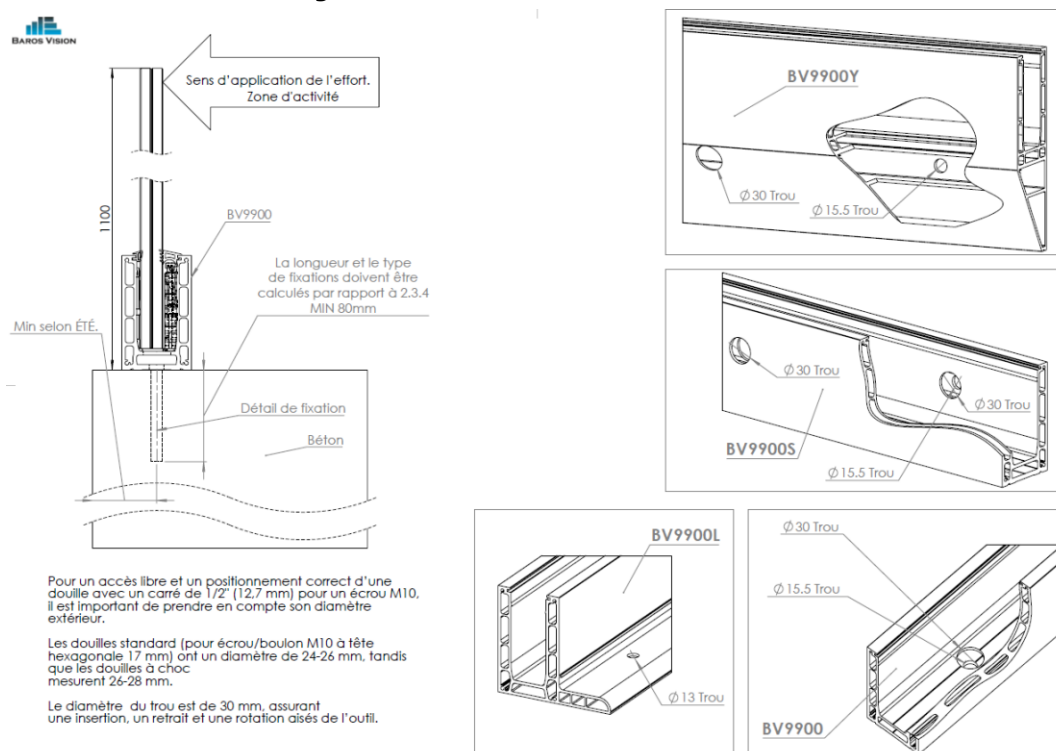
Instructions pour l'installation des systèmes sur ossature béton
